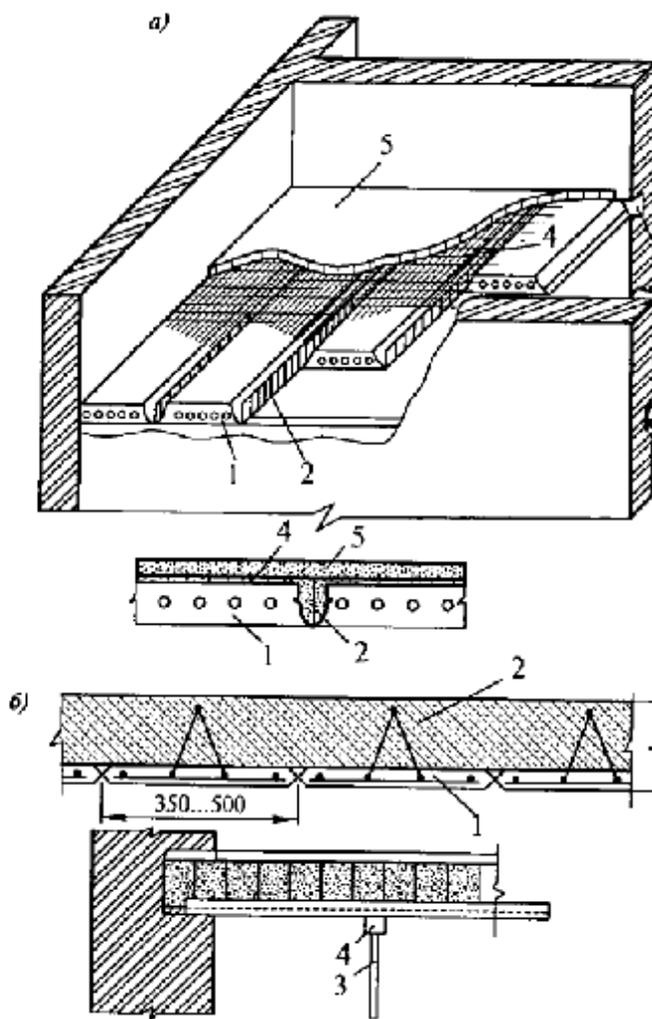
Сборно-монолитные перекрытия из пенополистирольных панелей: а — с армированием каркасами и обетонированием поверхности: 1 — пенополистирольная панель; 2 — армокаркас; 3 — штраба в кирпичной стене; 4 — арматурная сетка; 5 — слой бетона; б — из армоопалубочных пенополистирольных панелей: 1 — панель несъемной опалубки; 2 — слой монолитного бетона; 3 — телескопическая стойка; 4 — прогон
